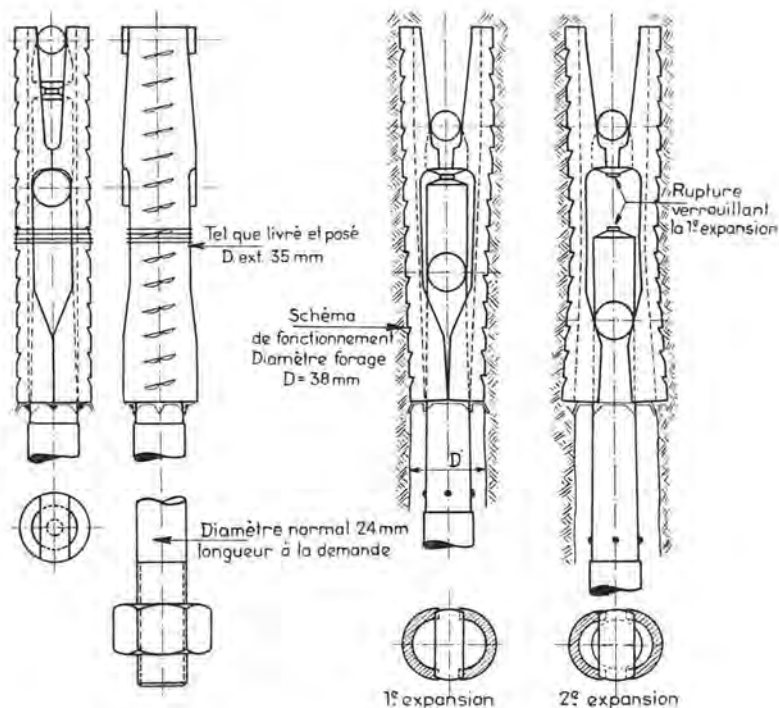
Vue en coupe du dispositif d'ancrage du boulon « Boltex ».
